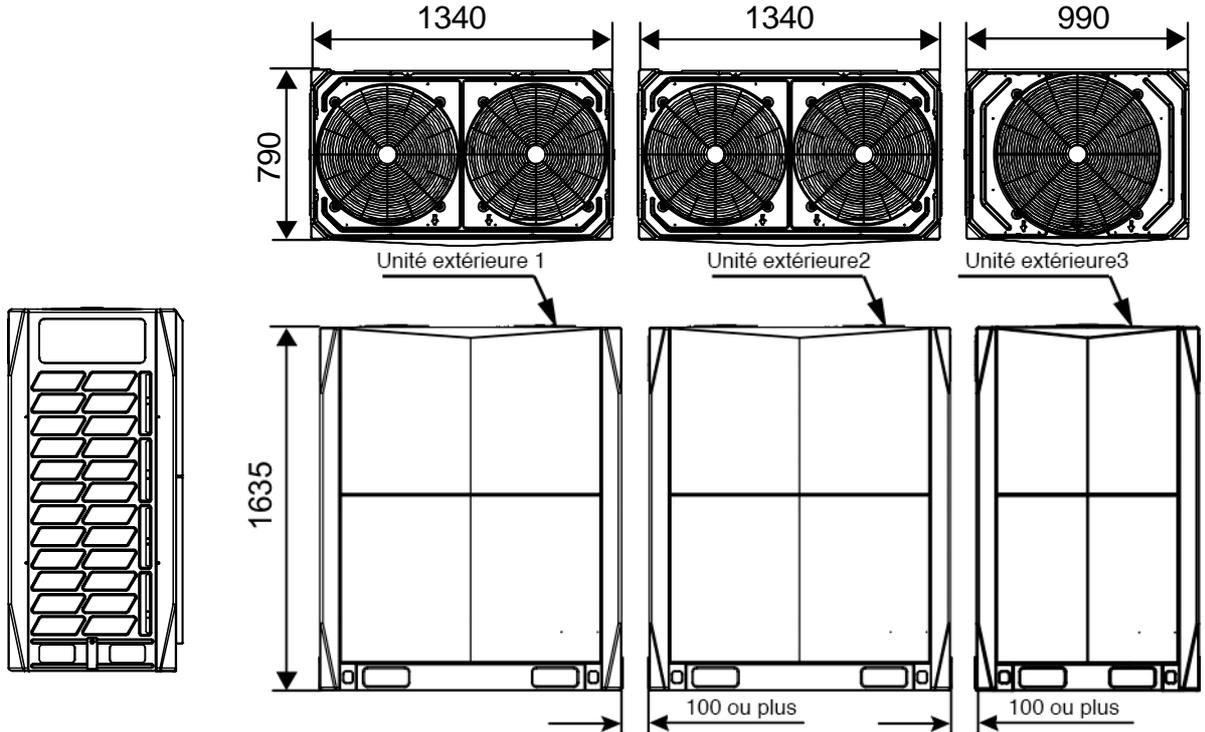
K2F-1285 DN4S dimensions (unité : mm)
